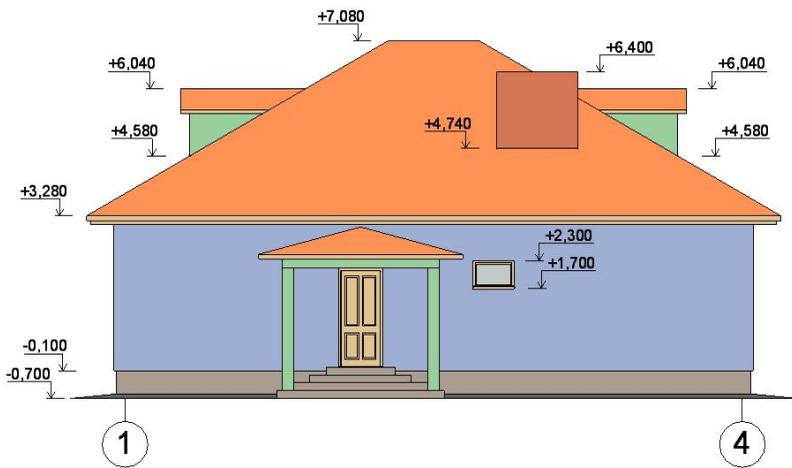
Главный фасад 1–4 (вальмовая крыша)
